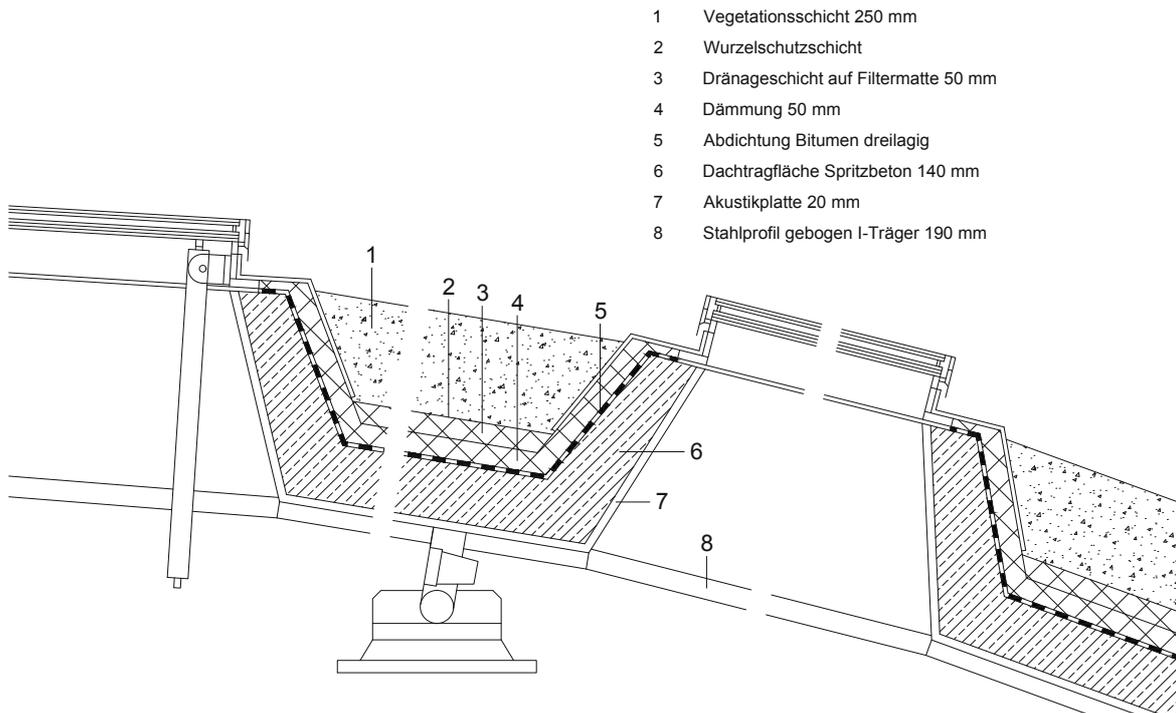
Dachbegrnung California Academy of Sciences – Aufbau, eigene Darstellung © Renzo Piano Building Workshop/Stantec Architecture, DETAIL Business Information GmbH [95]
